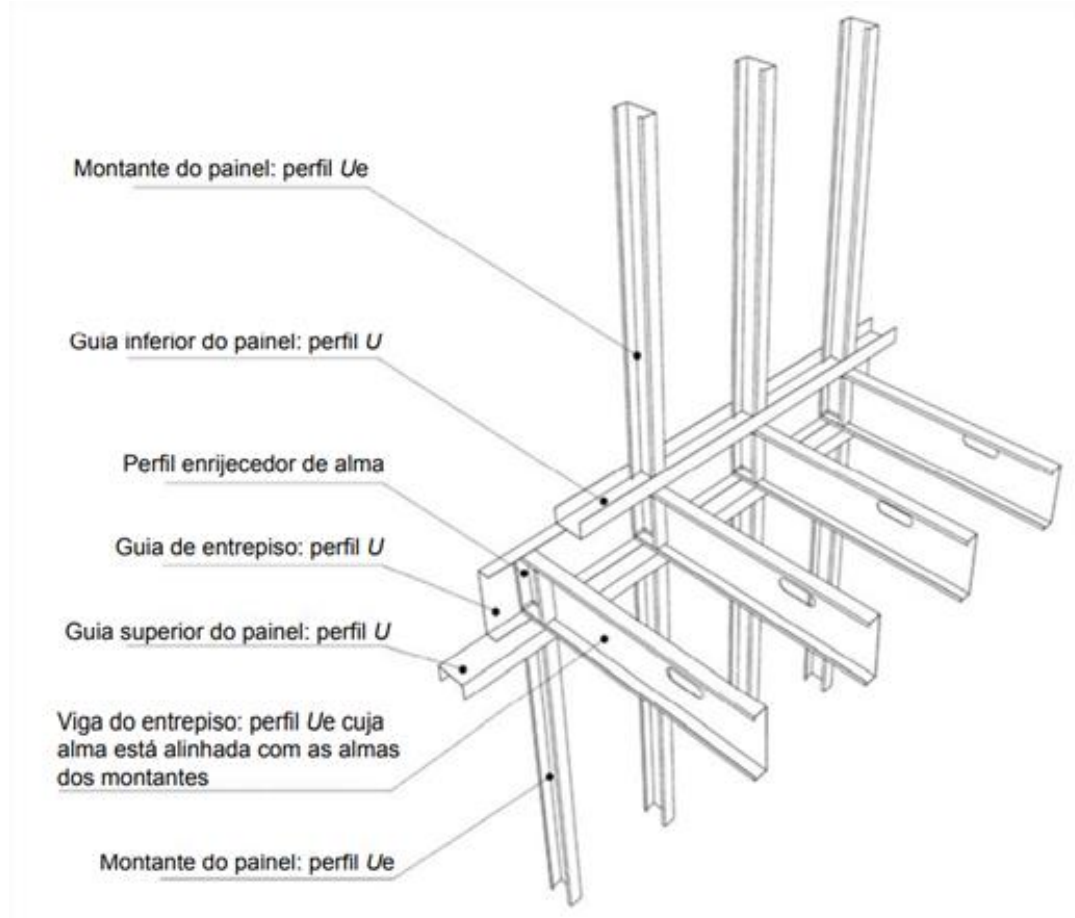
Detalhes dos elementos construtivos que compõe os painéis e as vigas de apoio para as lajes apresentados na NBR 15253. Fonte: ABNT (2014).
